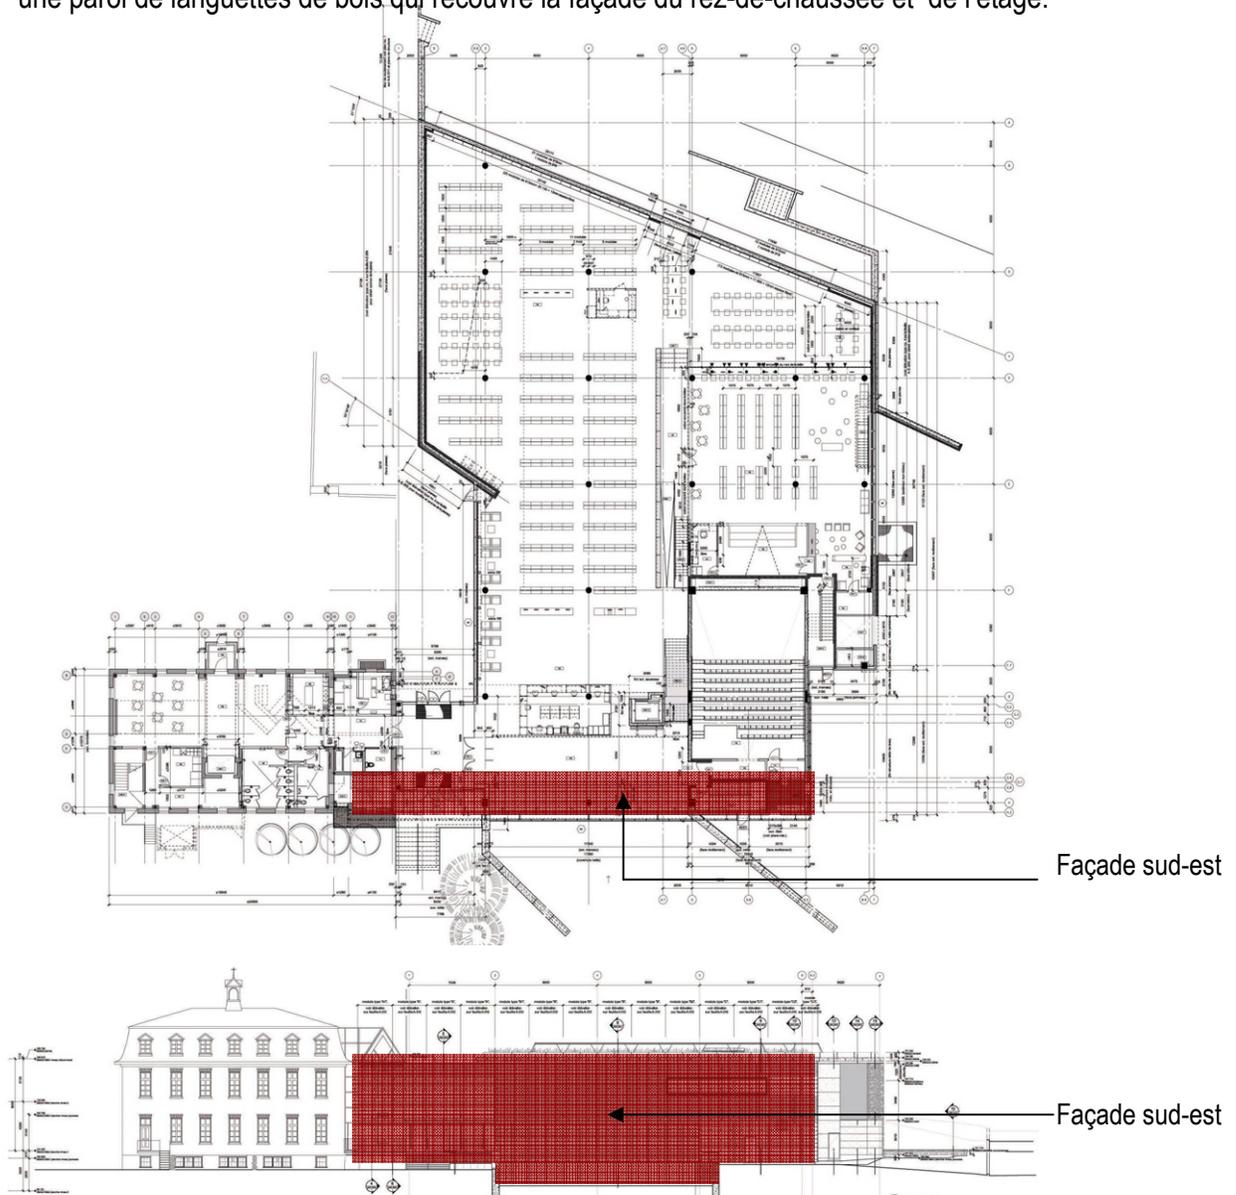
(A) Situation en plan et (B) en élévation du détail étudié (Source: Croft Pelletier Architectes)
